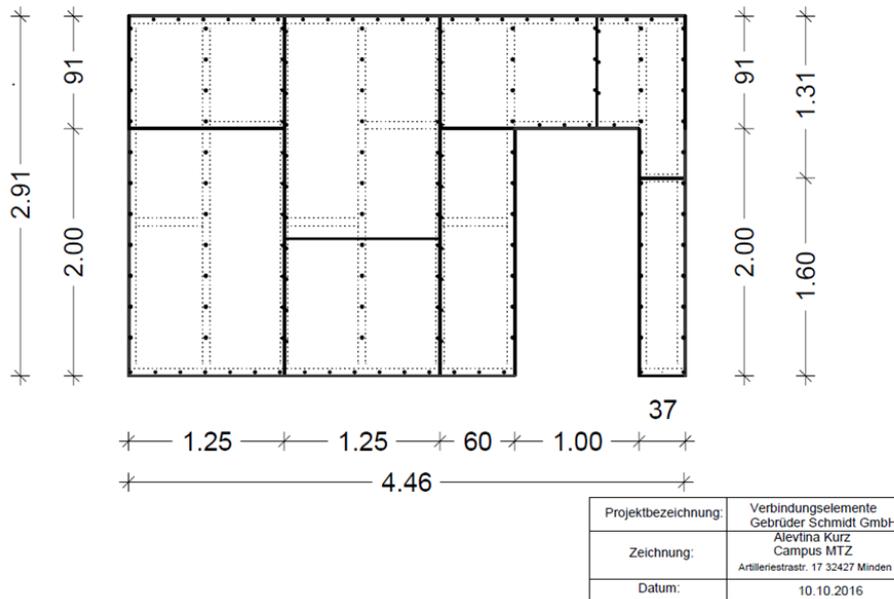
Anordnung der Gipskartonplatten für Holz-Ständerwerk mit Konventioneller Montage mit doppeltem Ständerwerk, Queraussteifung und Schrauben im Abstand horizontal ca. 20 cm und vertikal 25 cm)
